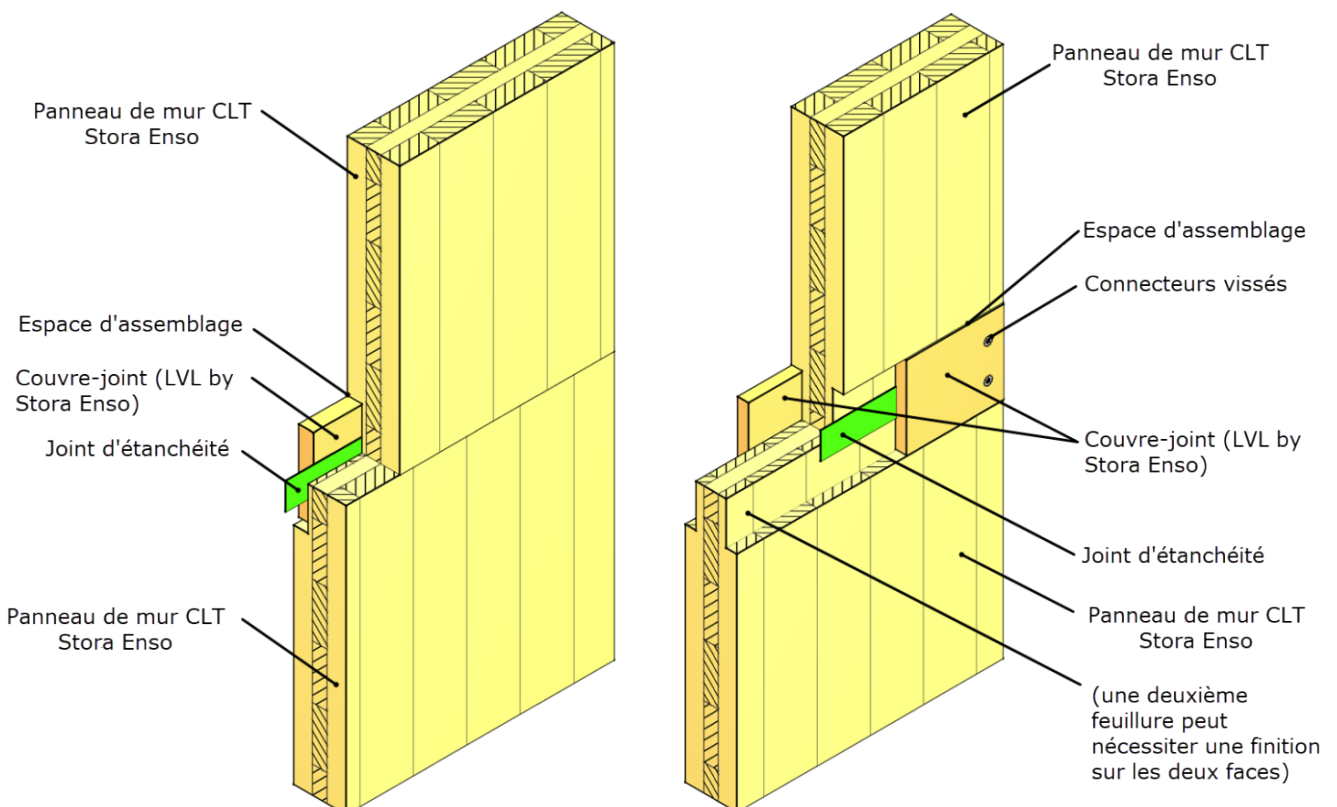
Exemples de liaisons (mi-bois et couvre-joint) entre deux panneaux de mur Stora Enso CLT adjacents dans le même plan.
